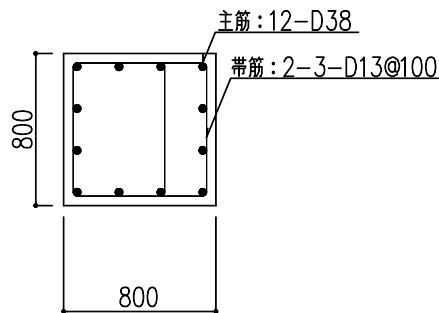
柱の配筋図 (地下2階, X4/YP 通り, 柱頭部) (単位:mm)
